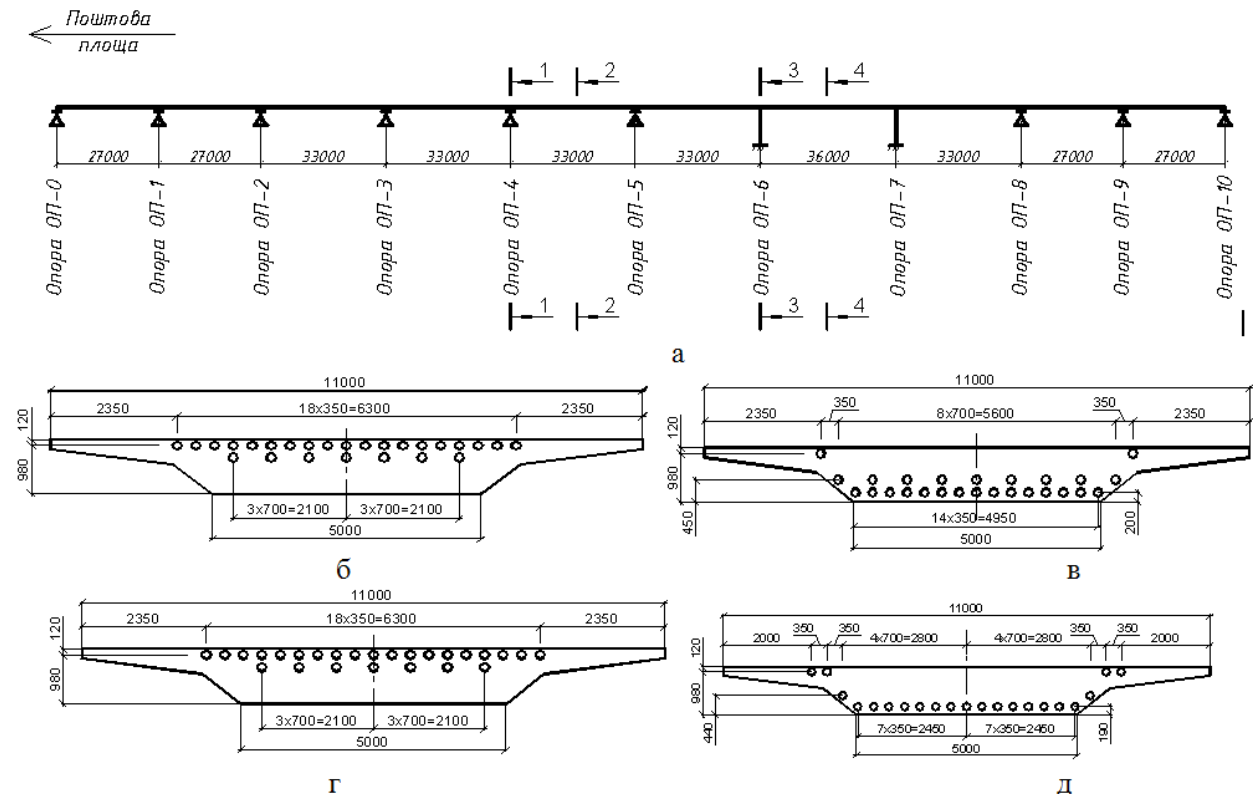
а – схема естакади; б – переріз 1-1; в – переріз 2-2; г – переріз 3-3; д – переріз 4-4
